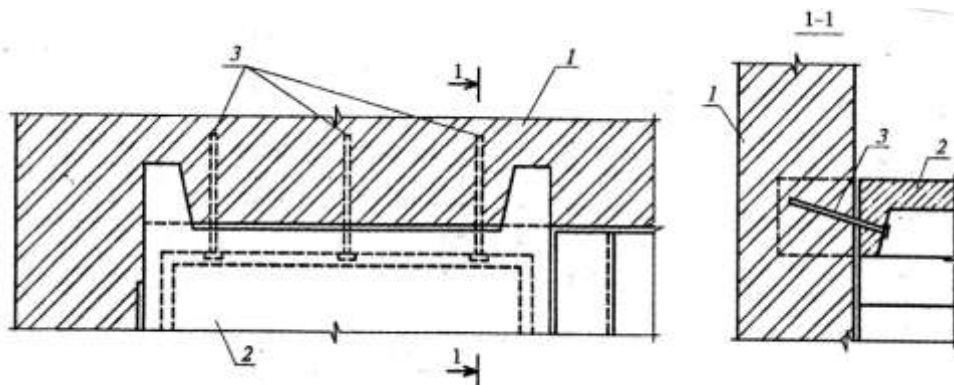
Анкеровка лестничных площадок к стенам лестничных клеток стальными анкерами: 1 – кирпичная стена лестничной клетки; 2 – лестничная площадка; 3 – анкера не менее $\varnothing 16$ длиной 200-250 мм под углом 30-45° к поверхности стены
